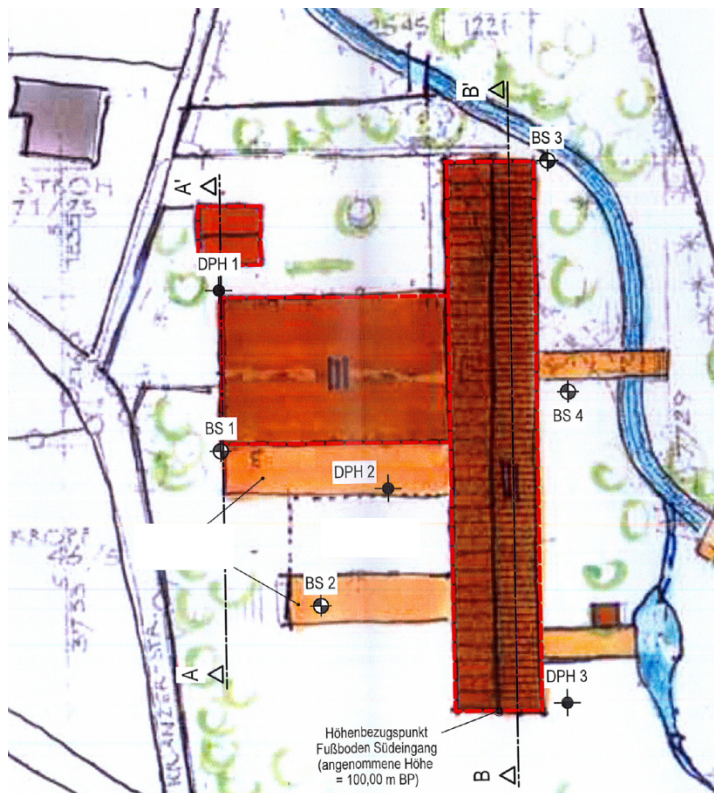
Lage der Baugrundaufschlüsse (ursprüngliche Planung zur Hotelerweiterung)
